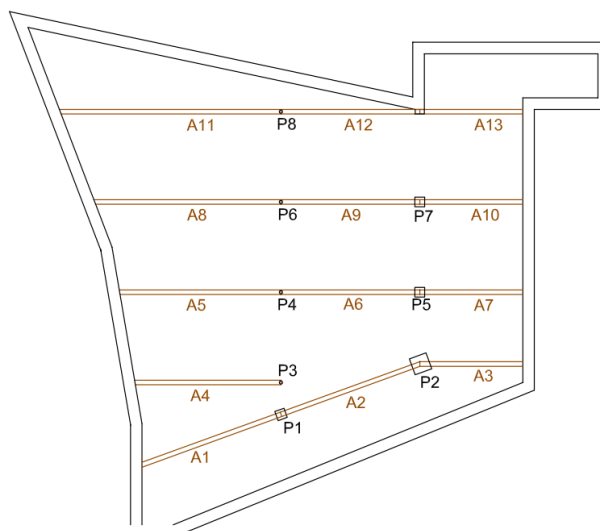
Planta da sala estudada. Localização das Asnas e dos Pilares
